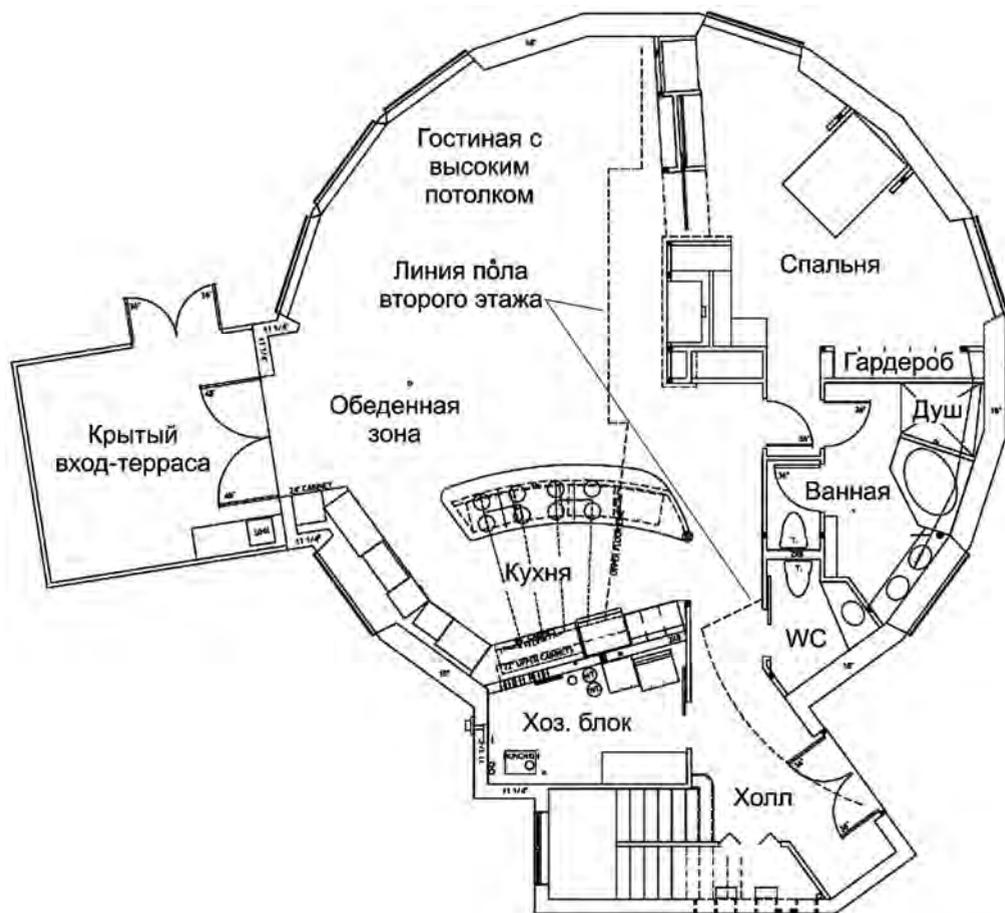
План первого этажа дома-купола The Bear Creek Dome
